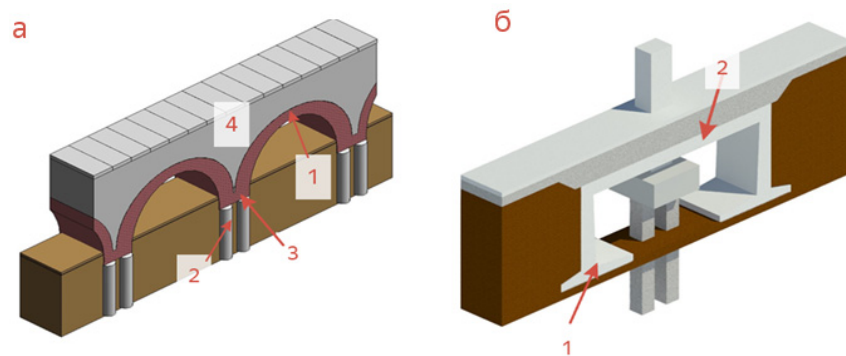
Устройство вентилируемых подполей: а — охлаждение грунтов основания при помощи аркад: 1 — арки, 2 — сваи, 3 — ростверк, 4 — насыпь; б — вентилируемые каналы: 1 — железобетонная подпорная стена, 2 — плита перекрытия над каналом (выполнено по аналогии [22])
